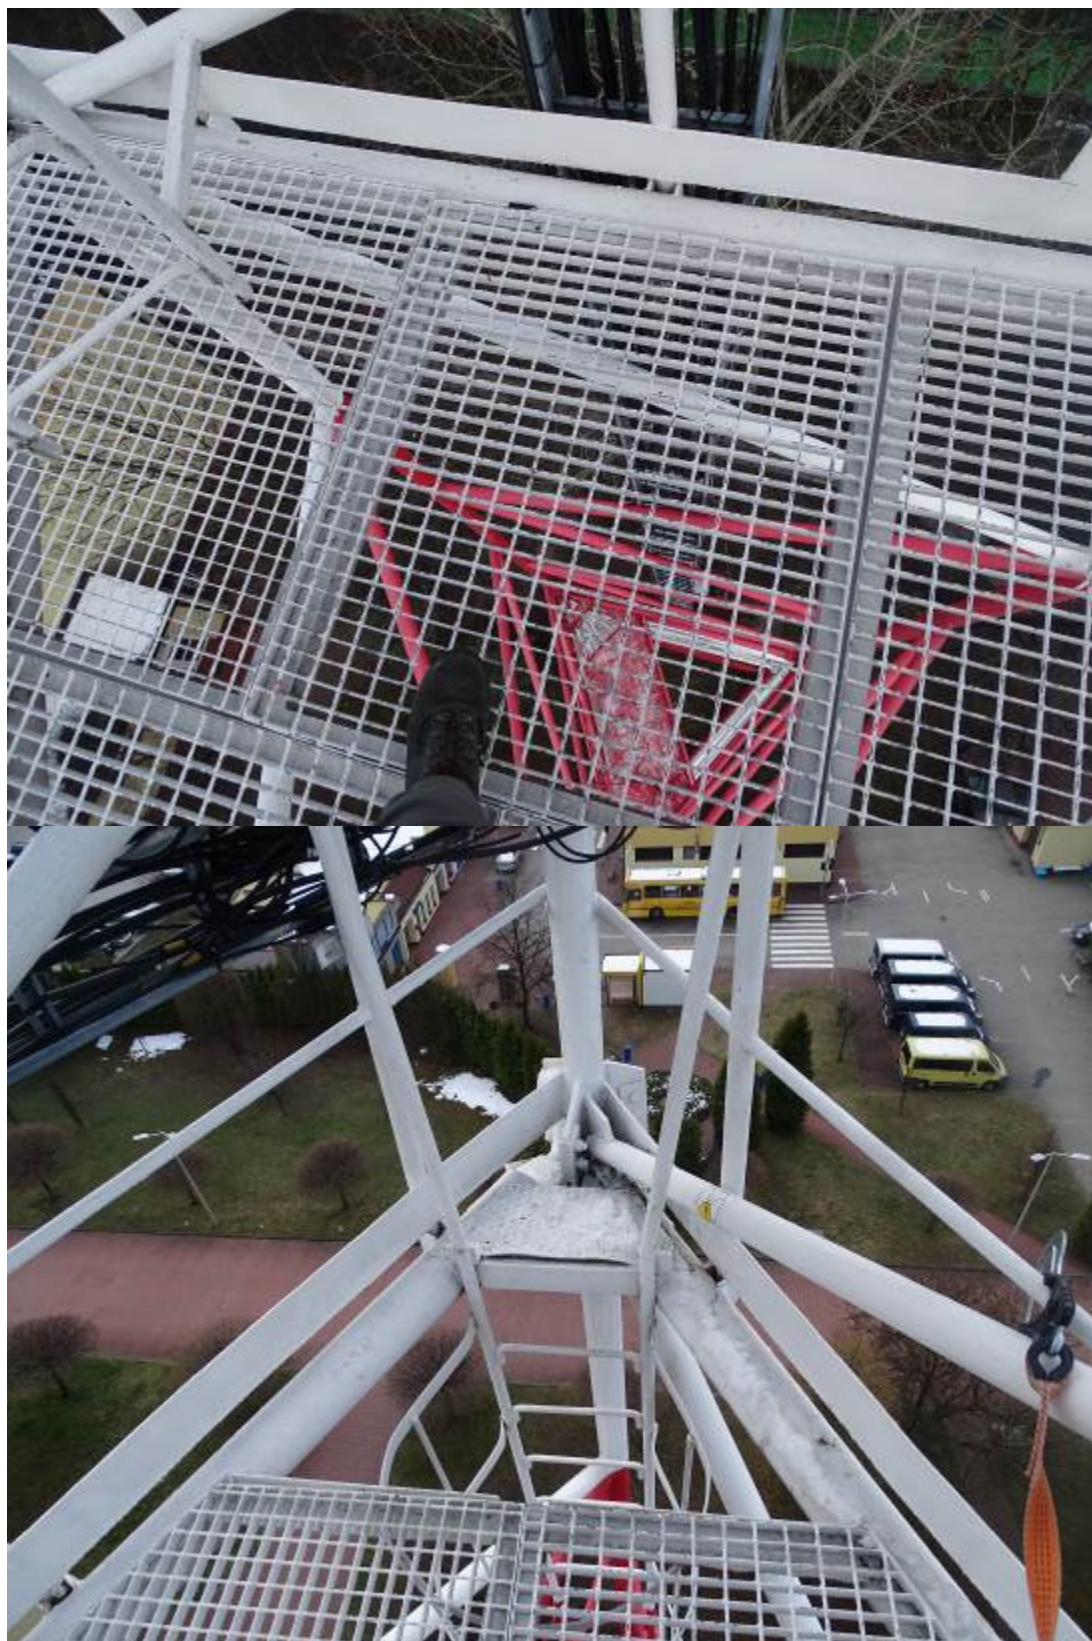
Segment 2 – konstrukcje wsporcze PLAY
